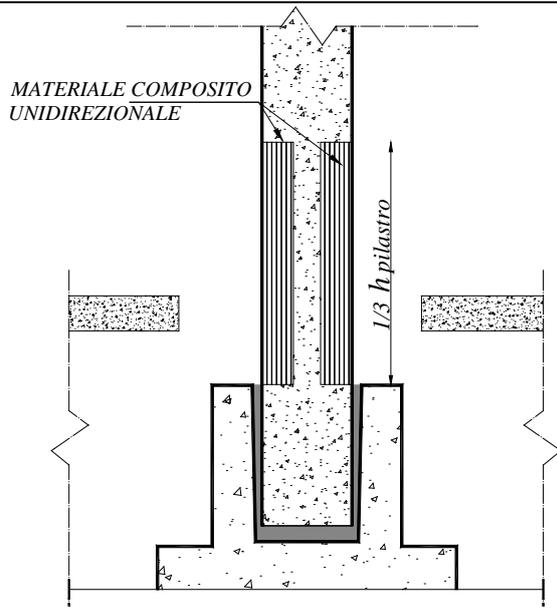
Applicazione del tessuto metallico. Sezione verticale
